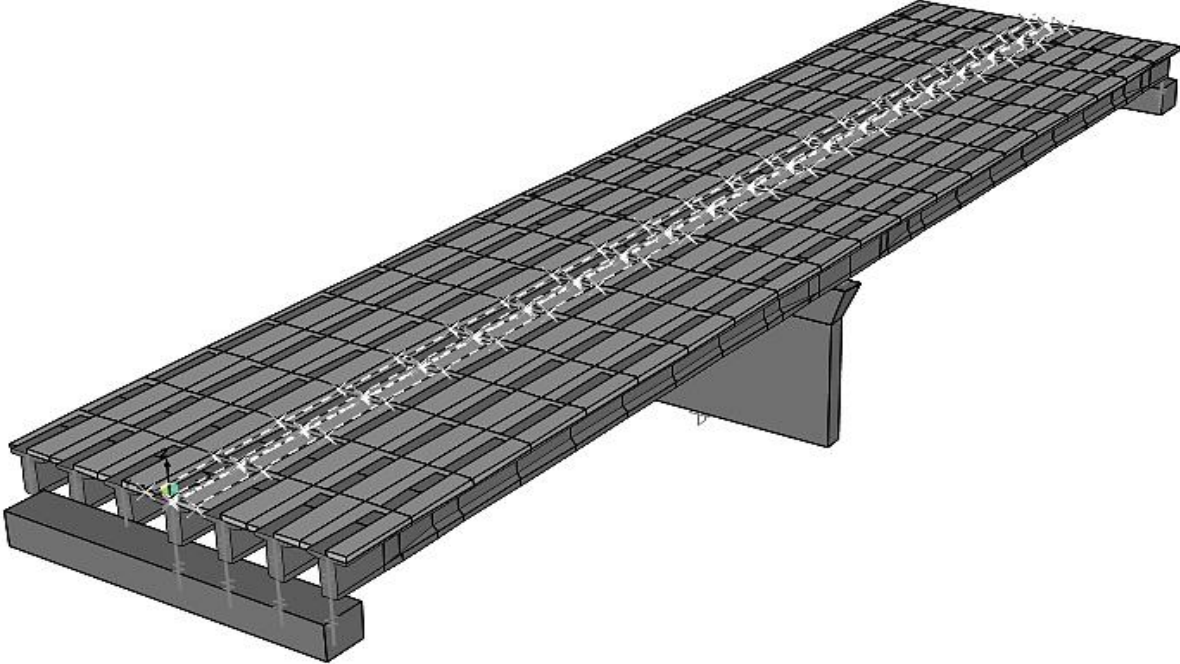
la poutre la plus sollicitée (poutre 3) sue le modèle
